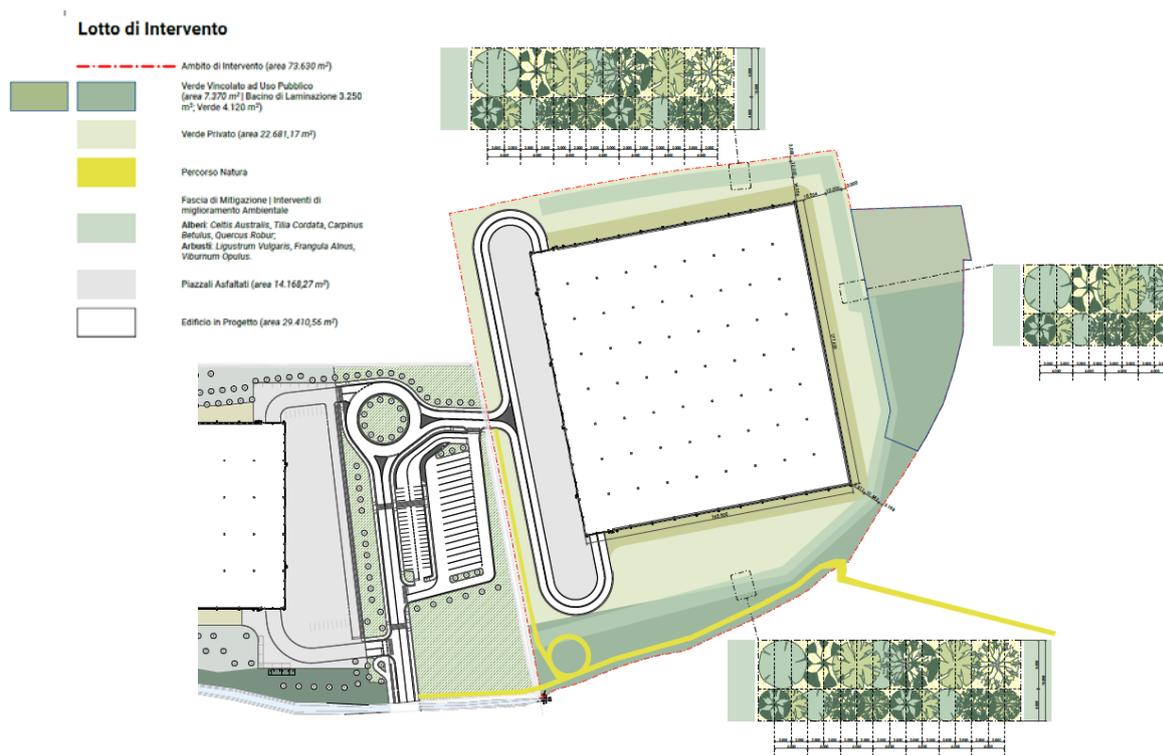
Planimetria generale con opere di mitigazione a verde
